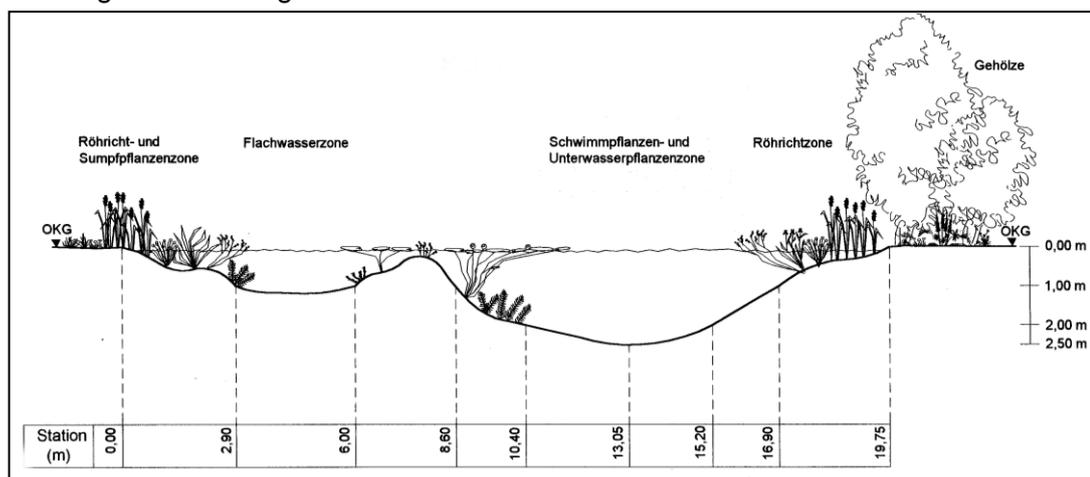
Gewässerquerschnitt eines naturnahen Regenrückhaltebeckens (schematisch).
